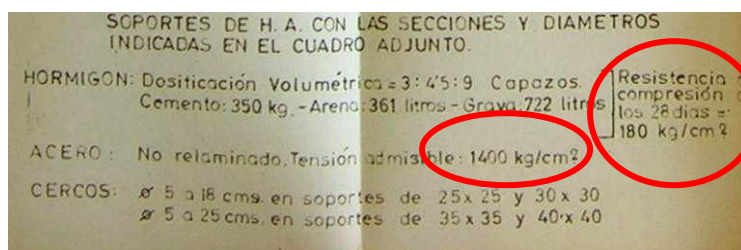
Leyenda plano de estructuras. Edificio ficha 215C.015, 1969.
